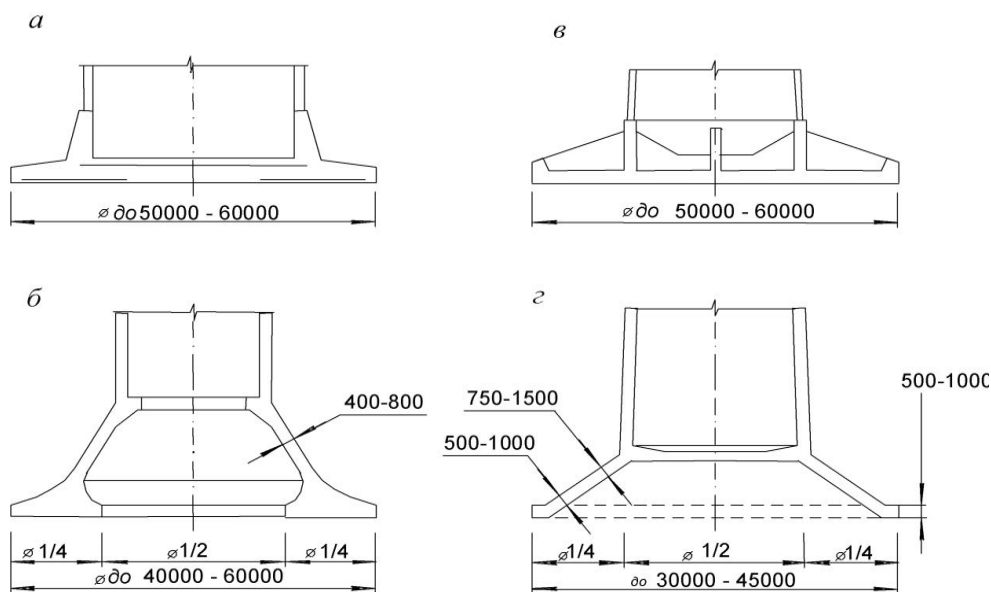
Фундаменти під споруди баштового типу:
